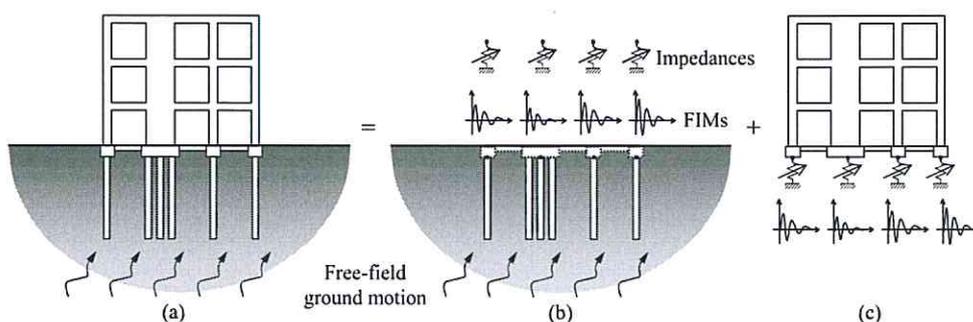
Approccio per sottostrutture: (a) sistema completo terreno-fondazione struttura; (b) sistema terreno-fondazione e (c) sovrastruttura
